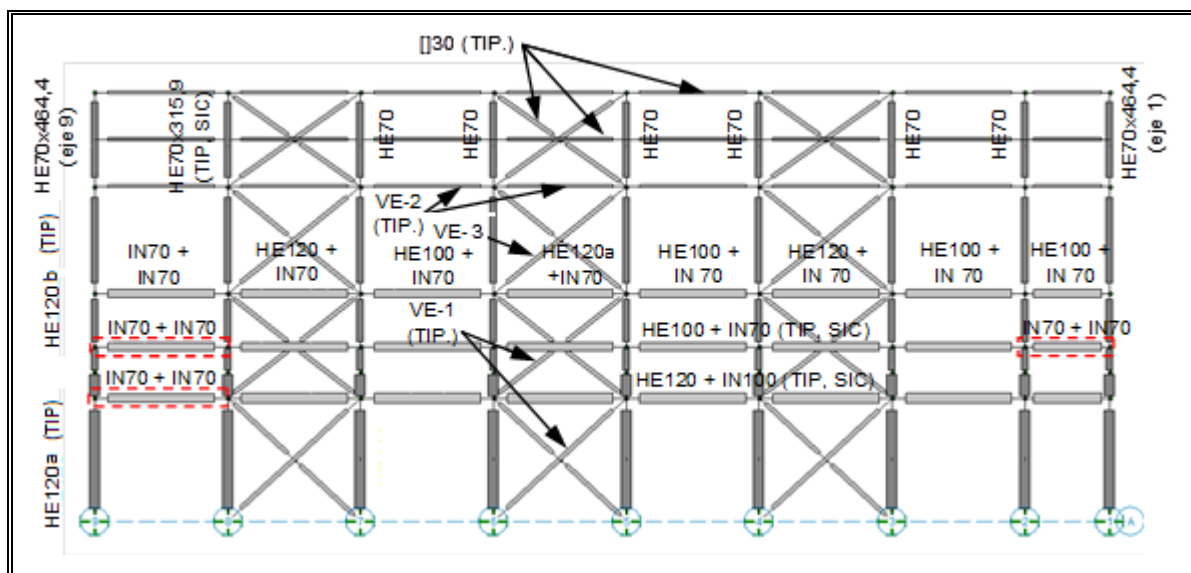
Perfiles Estructurales Dispuesto en Eje H.
